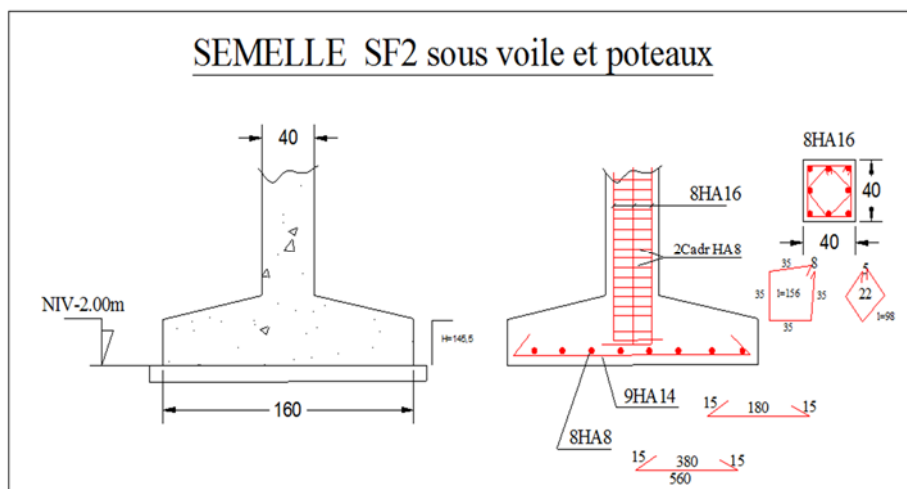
Ferrailage de la semelle filante sous deux poteaux et un voile
